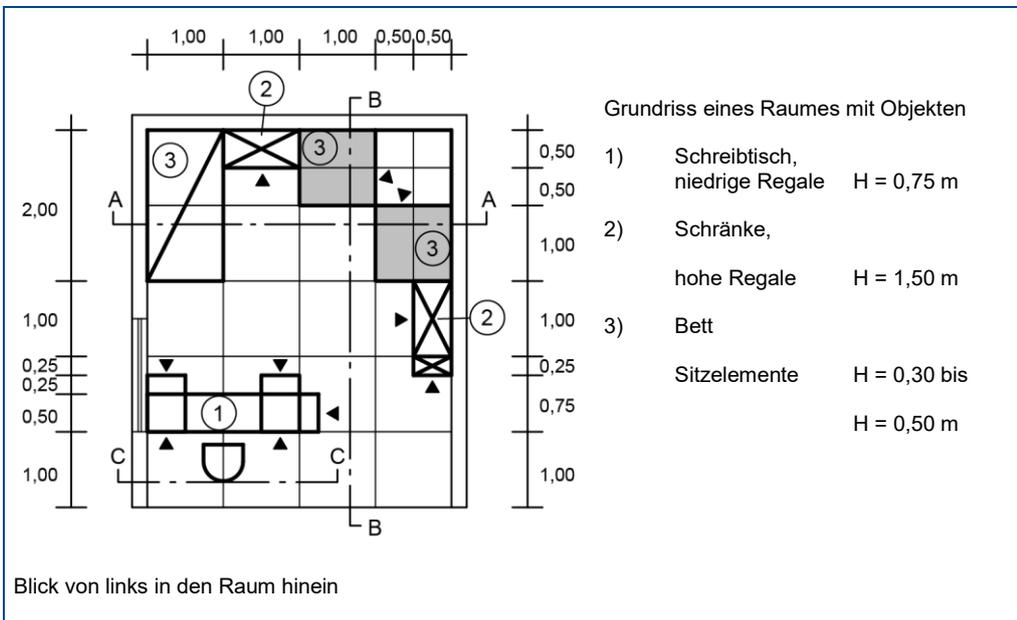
Grundrissbeispiel für die Konstruktion einer Übereckperspektive als räumliches Raster
